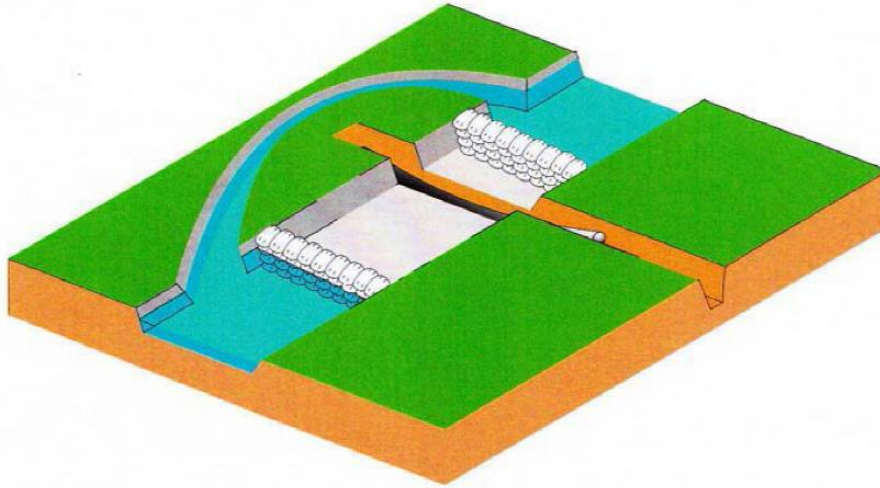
围堰导流开挖管沟法施工断面示意图
